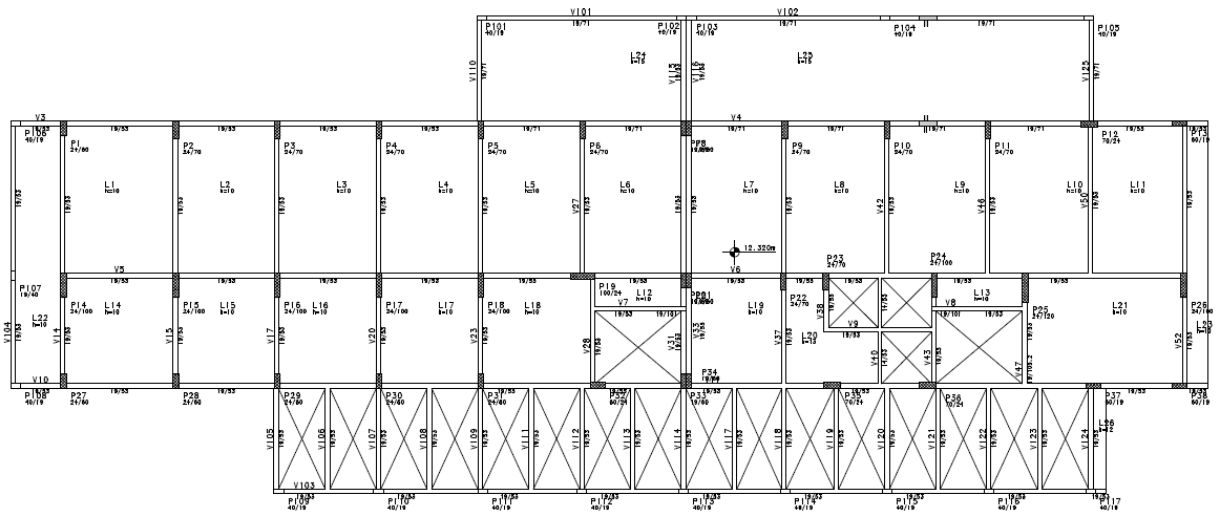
Conceção do 2º pavimento. (Fonte: Autor, 2023)
